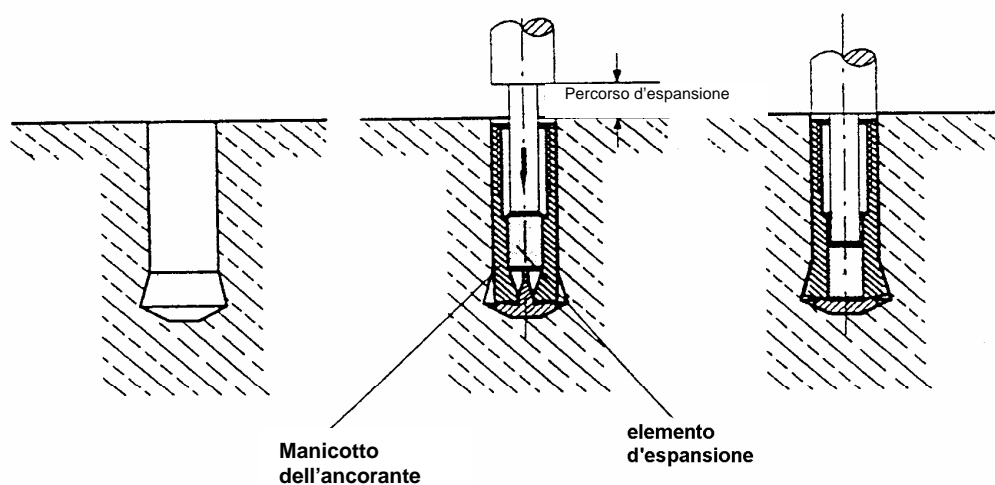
Installazione dell'ancorante battendo l'elemento di espansione (cono) nel manicotto dell'ancorante
